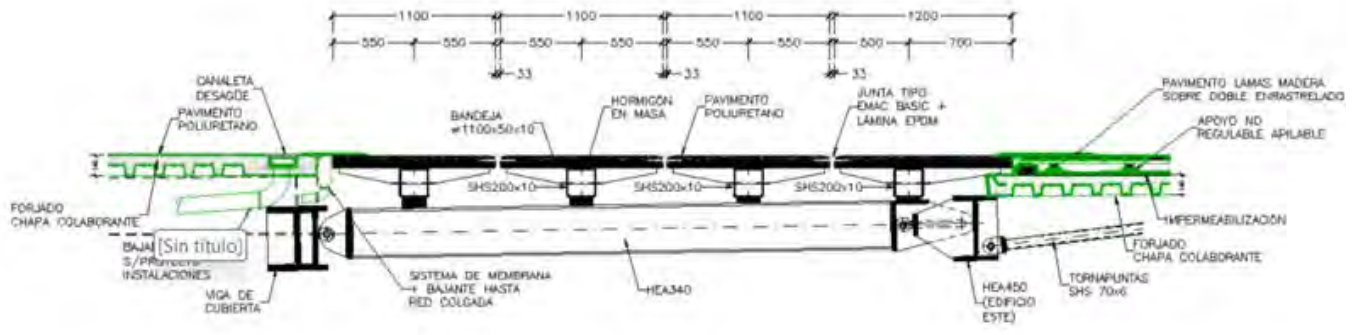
Sección de proyecto de una de las losas de transición. En verde los forjados de las secciones oeste (izquierda) y sur (derecha) del skywalk. En el centro el planteamiento de proyecto para configuración de las “teclas”. Esquema en sección de fase de estudio de proyecto.
